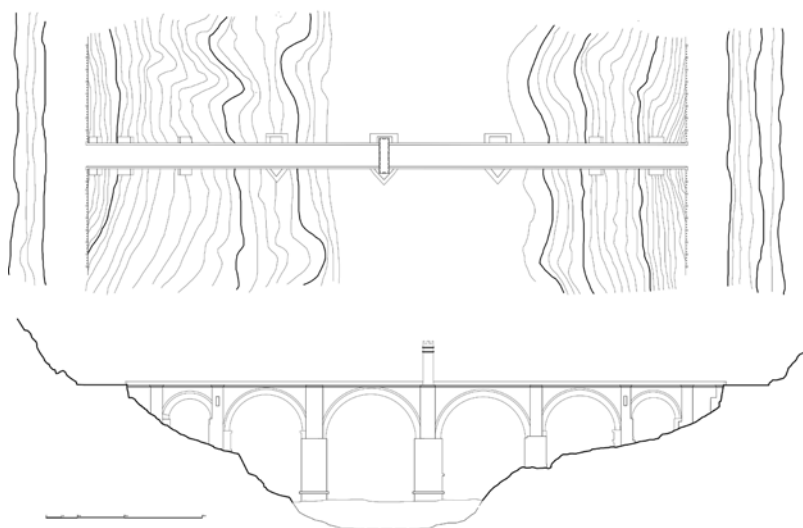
Ponte di Alcántara, modelli geometrico 2D. Pianta e prospetto sud-ovest (elaborazione di Carlo Inglese).
